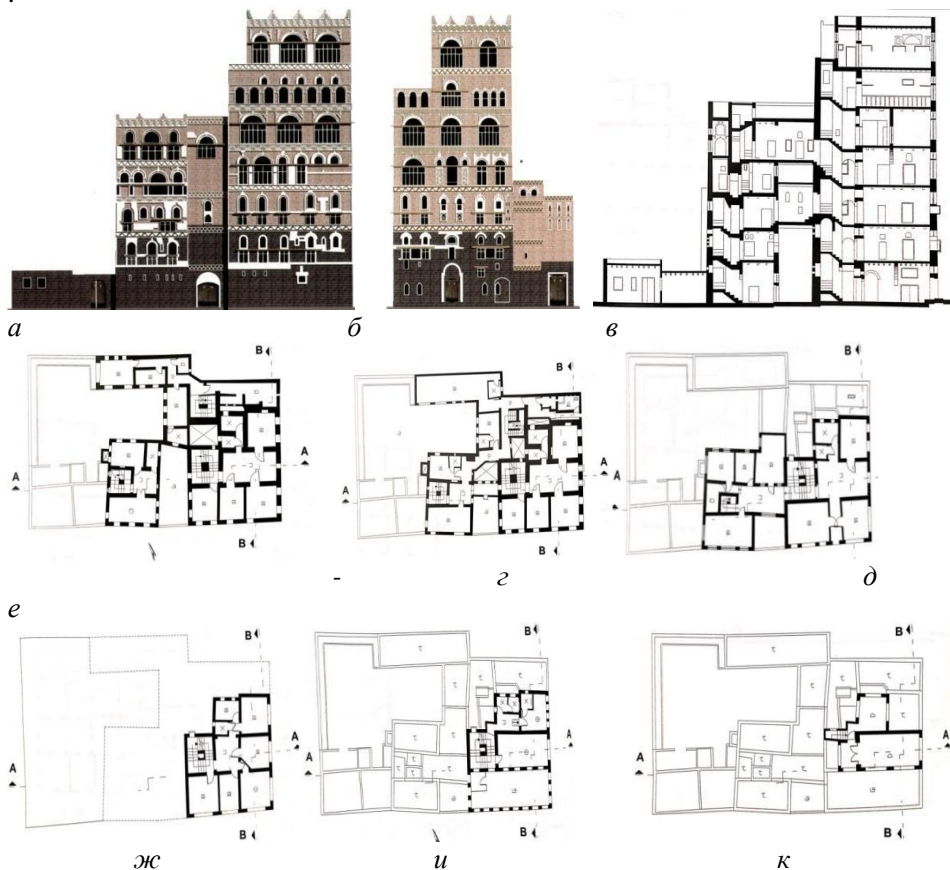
Историческое здание старого города Сана: а – южный фасад; б – западный фасад; в – разрез; г – план 1-го этажа; д – план 2-го этажа; е – план 3-го этажа; ж – план 4-го этажа; и – план 5-го этажа; к – план 6-го этажа
